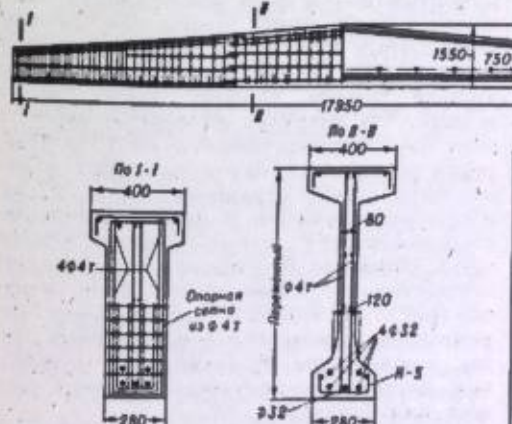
Двускатная балка пролетом 18 м, армированная стержневой арматурой.
